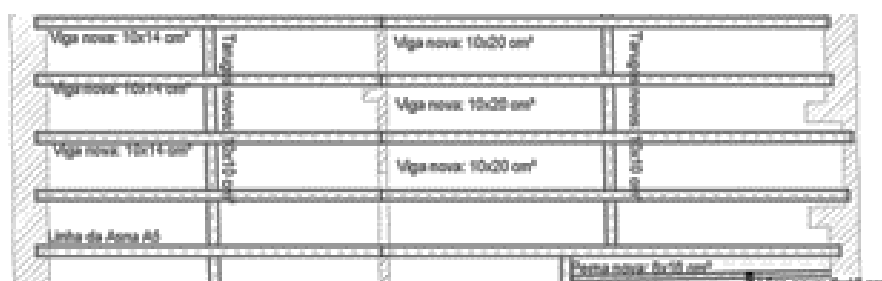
Planta estrutural do pavimento PVRR_1
